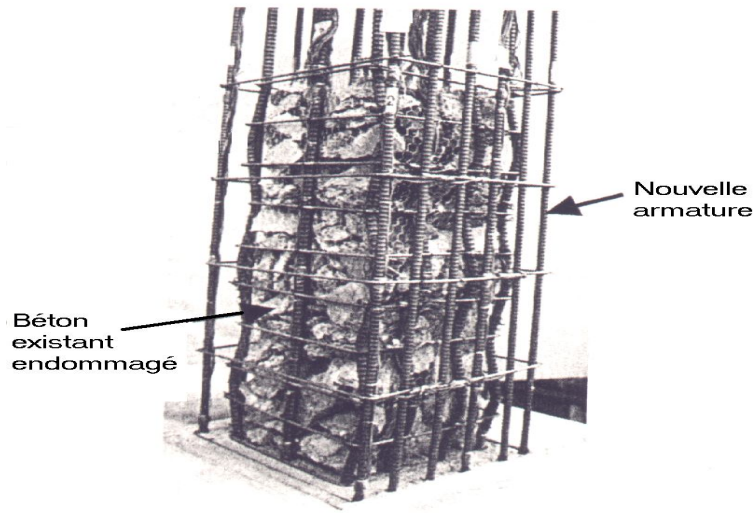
Dispositif de ferrailage avant le coulage du béton
